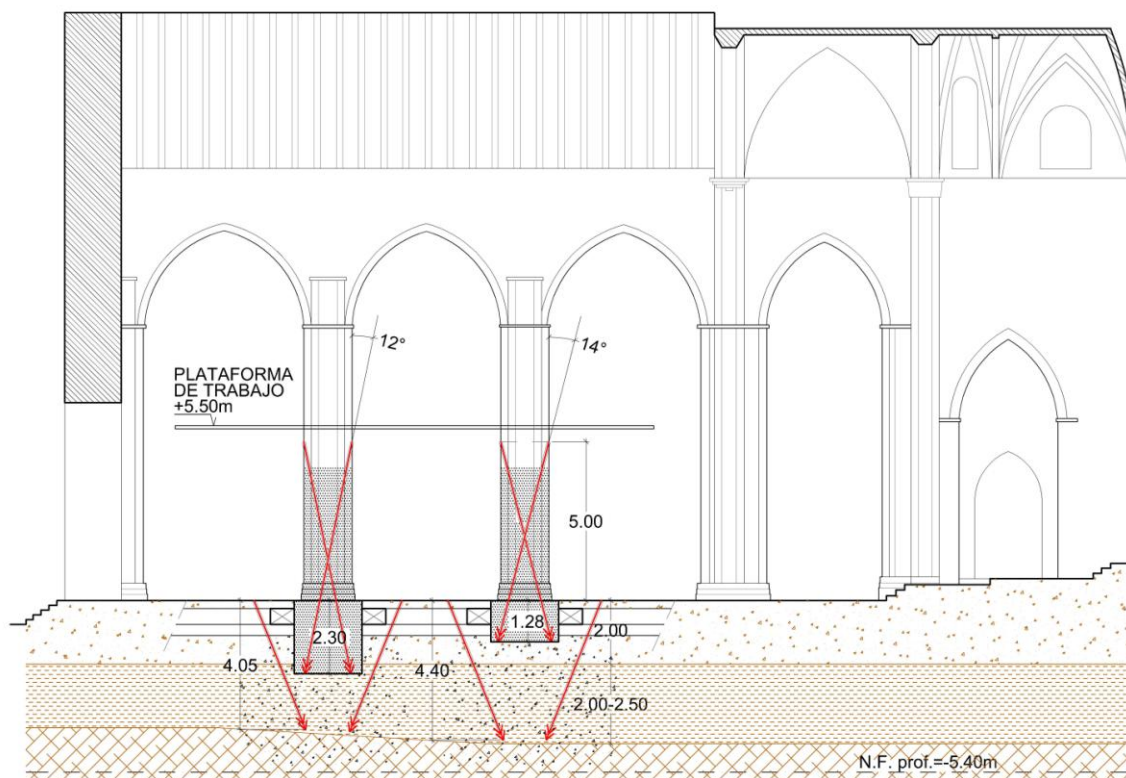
Esquema del tratamiento en sección de los pilares y la cimentación.
